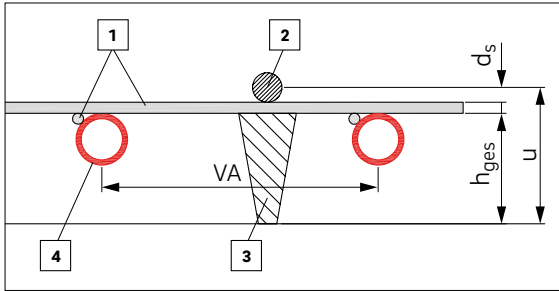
Aufbau untere Bewehrung, Schnitt (Detail)
